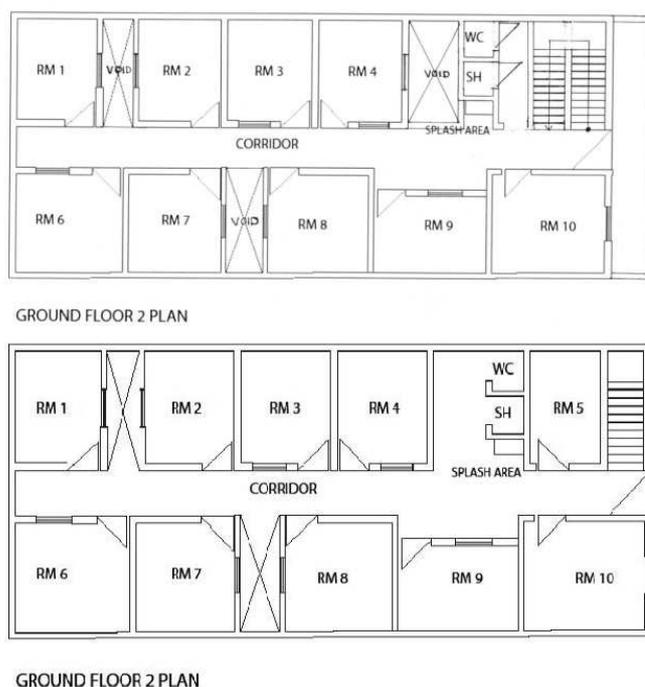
Planta tipo de un bloque de tres plantas encajado entre medianeras, *cluster 4
